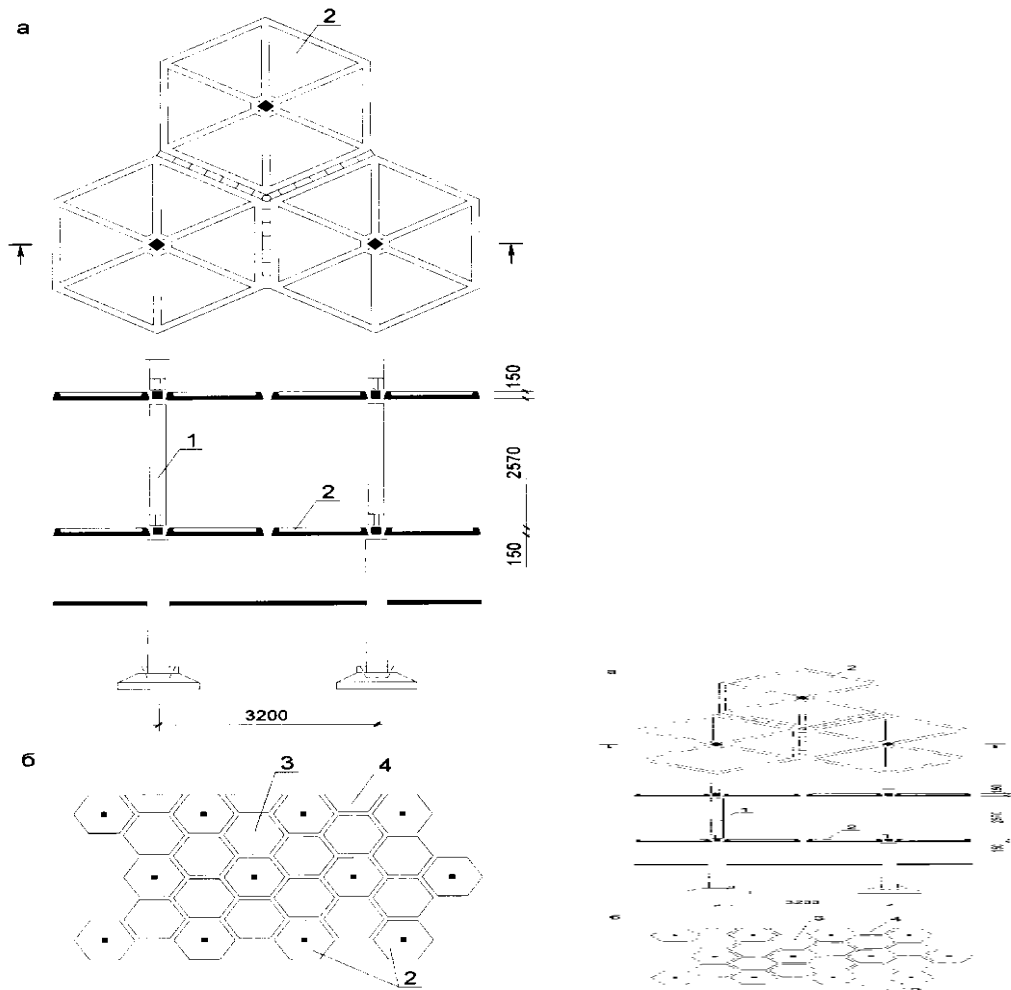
Безригельный грибовидный каркас с плоскими перекрытиями (Украина): а - на треугольной сетке колонн со стороной 3,2 м; б - на треугольной сетке со стороной 6,6 м; 1 - колонна; 2 - надколонная (капительная) плита; 3 - пролетная плита; 4 - доборная фасадная плита
